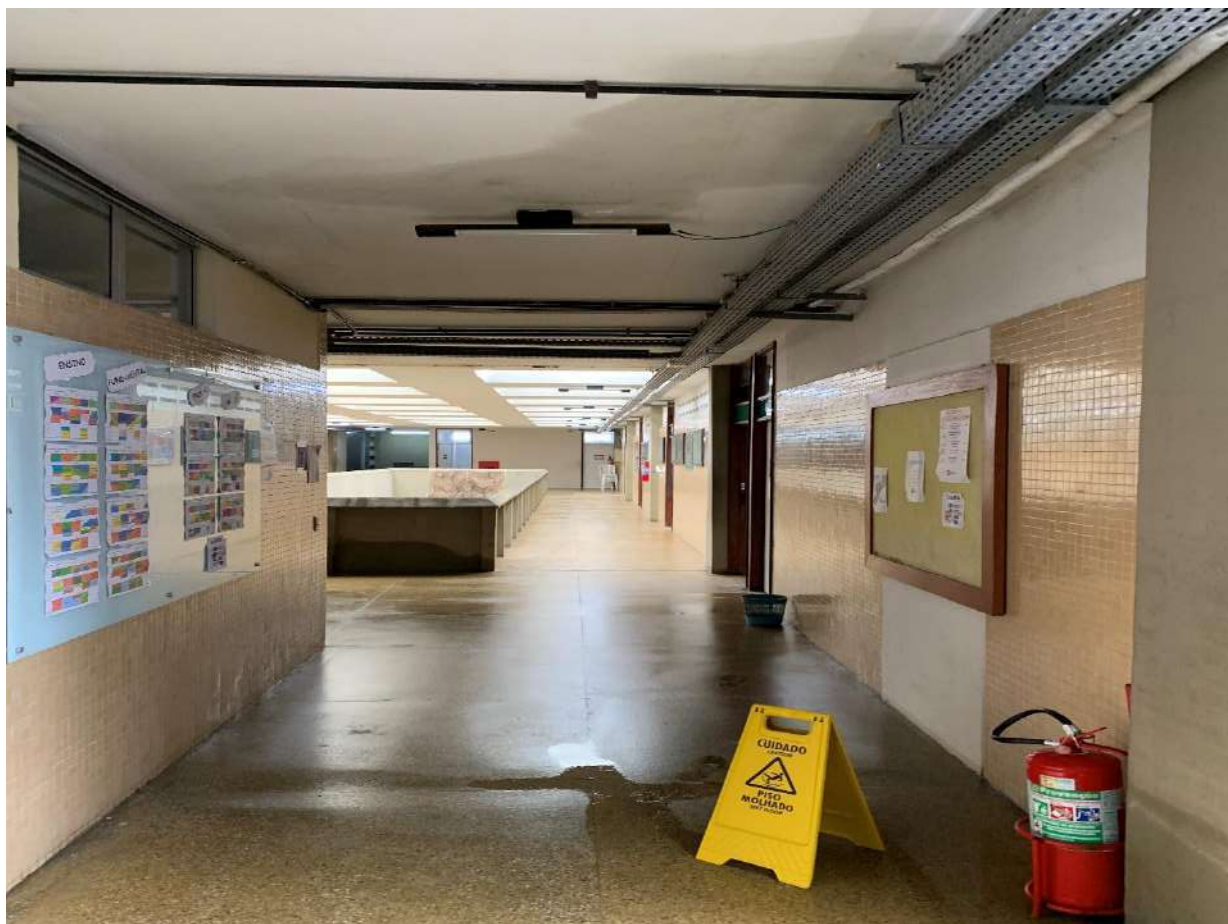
Infiltração em teto em sala de aula 2º pavimento CAP
